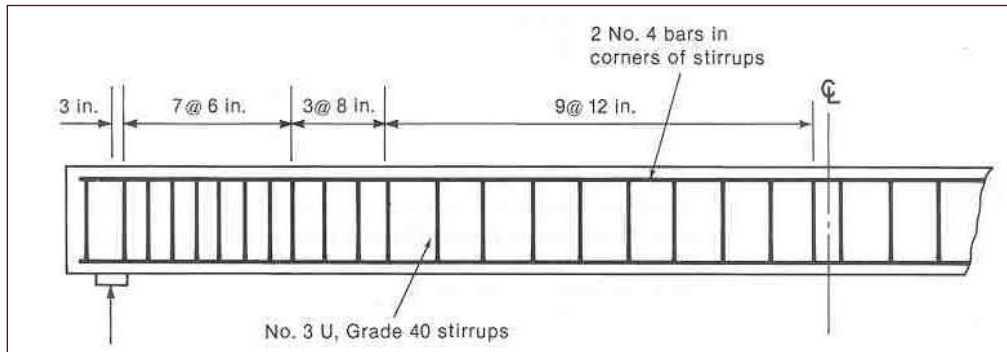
Distribución de estribos en viga—Ejemplo 5-1.
